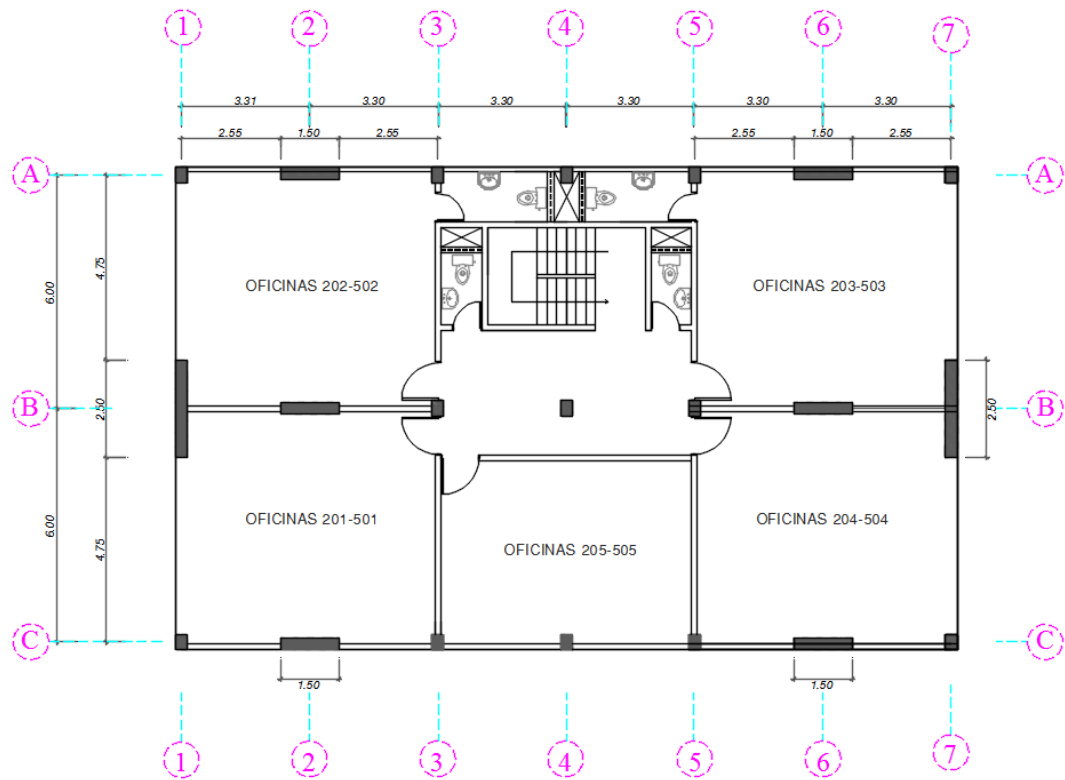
Vista en planta de arquitectura del piso típico (segundo al quinto piso)
